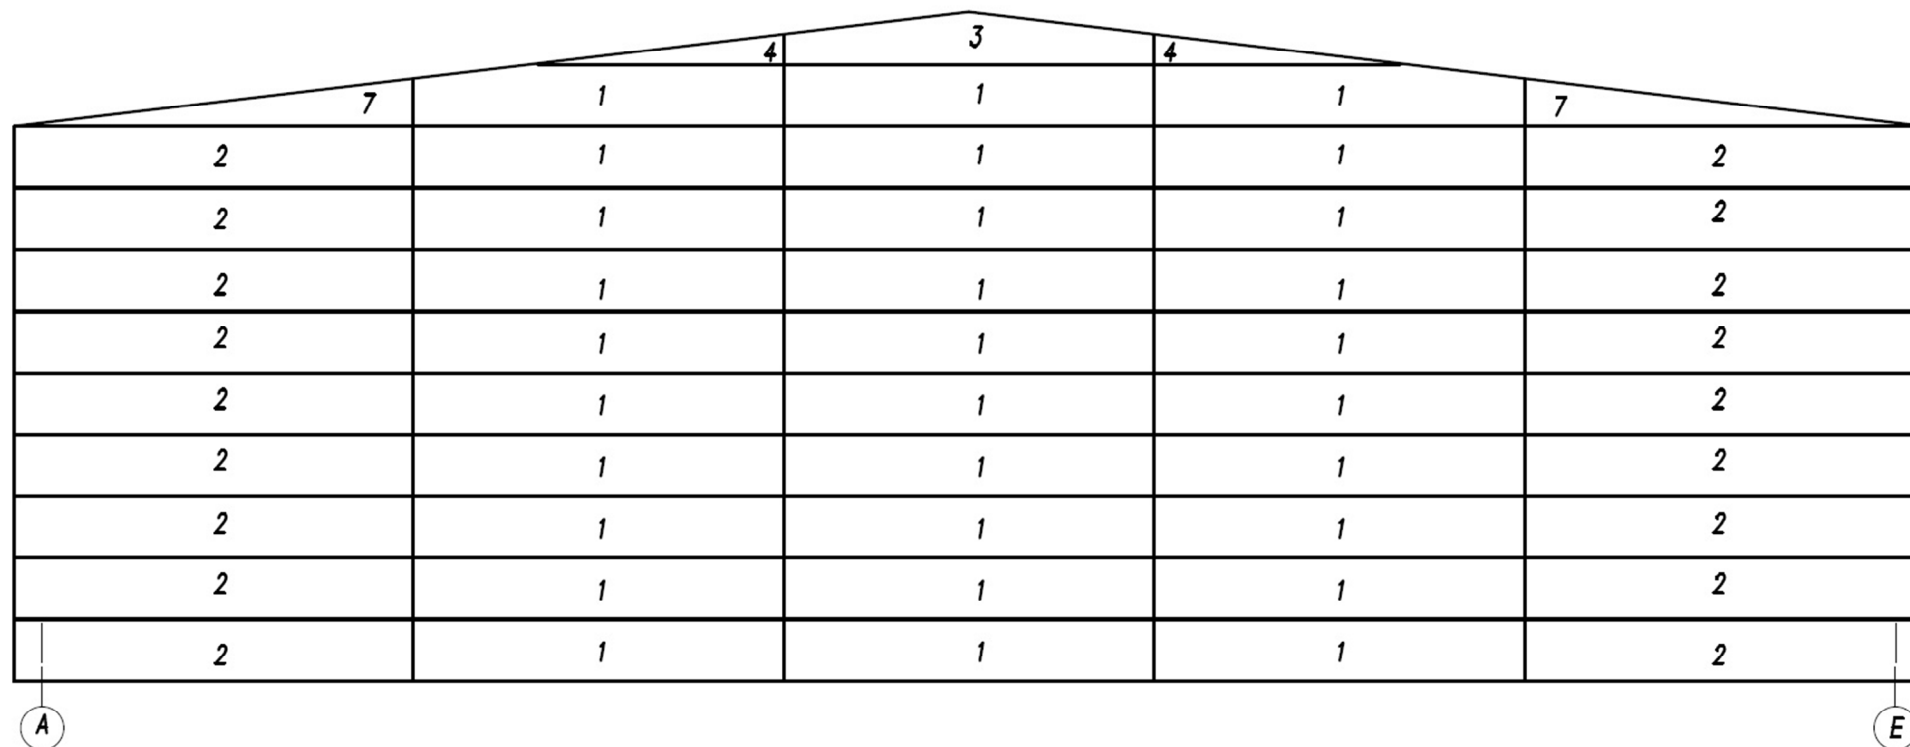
«Схема раскладки стеновых сэндвич-панелей фасад А-Е» [1]
